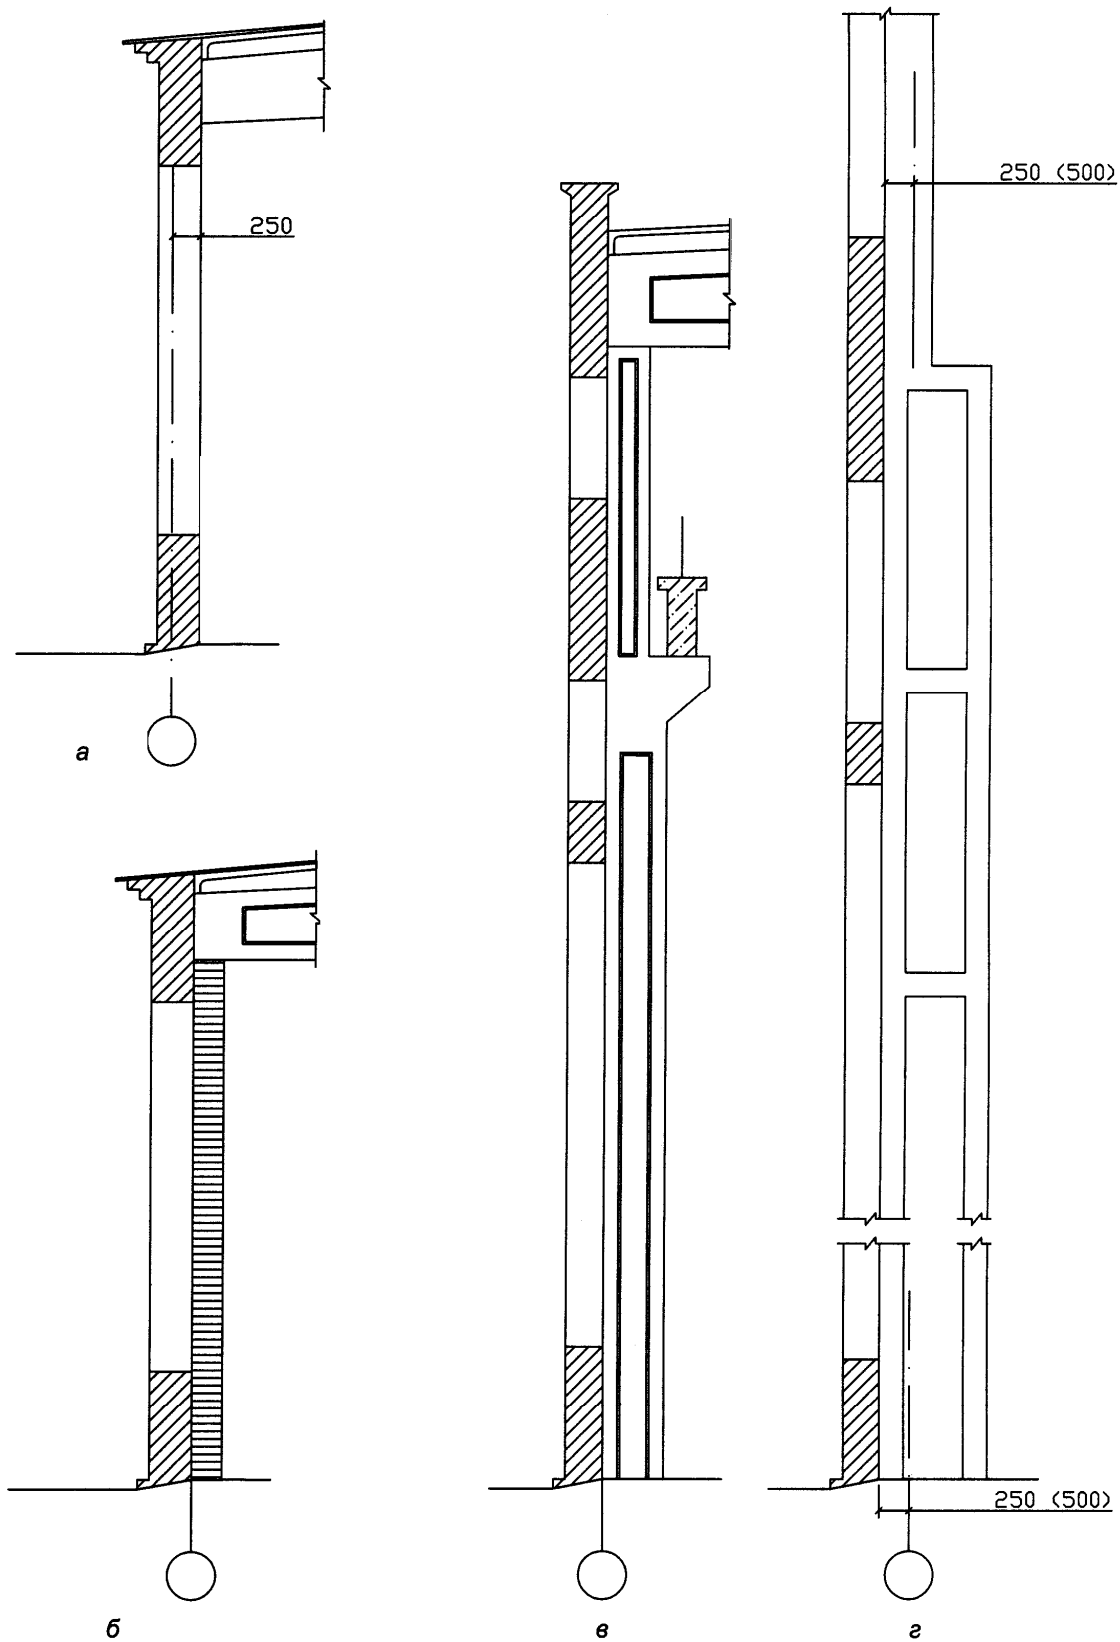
Схеми прив'язки стін будівлі до поздовжніх роздільних осей
